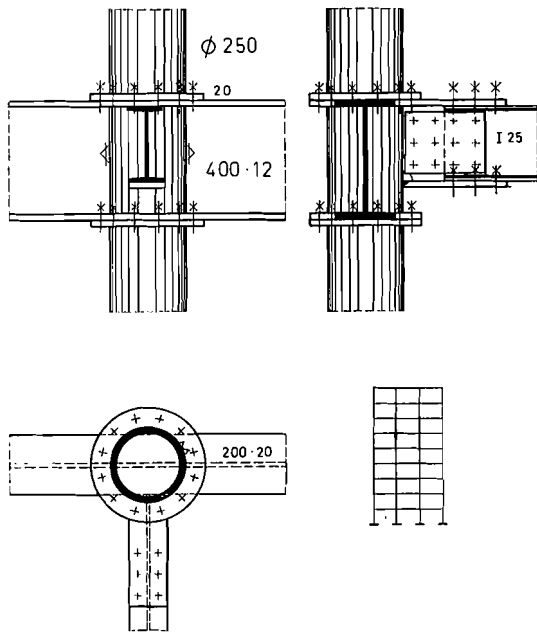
Rahmenknoten mit unterbrochener Stütze und durchgehendem Unterzug, Baustellenanschlüsse geschraubt
